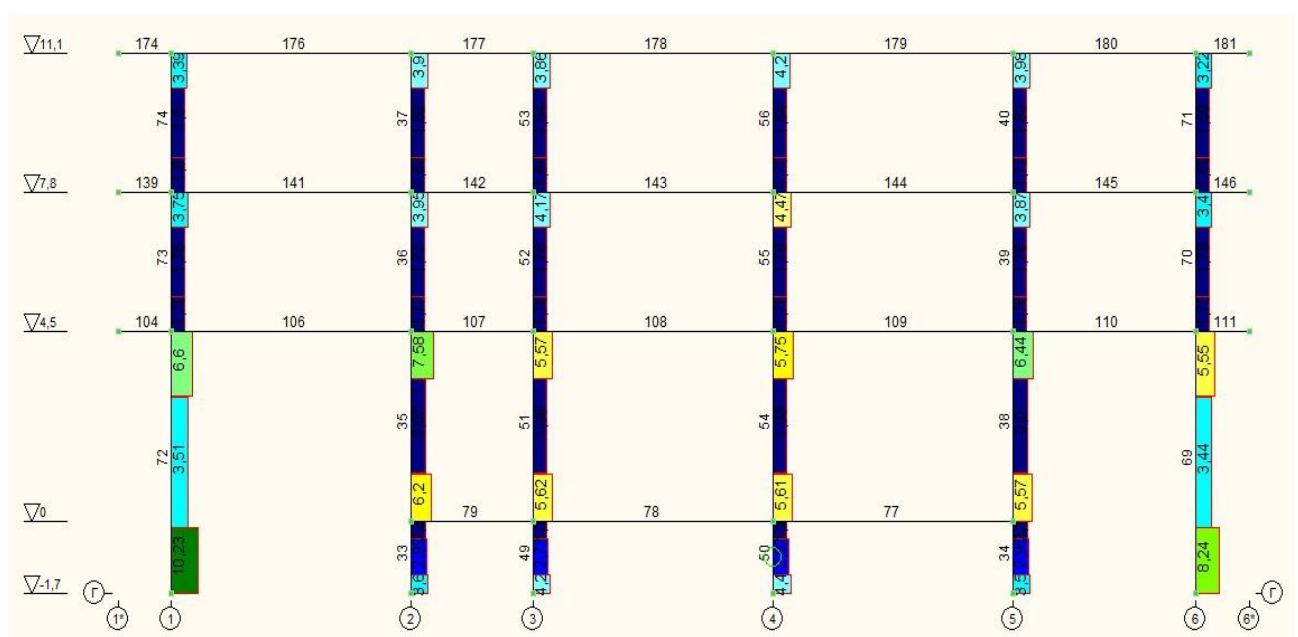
Сумарна площа поперечної арматури, см²
